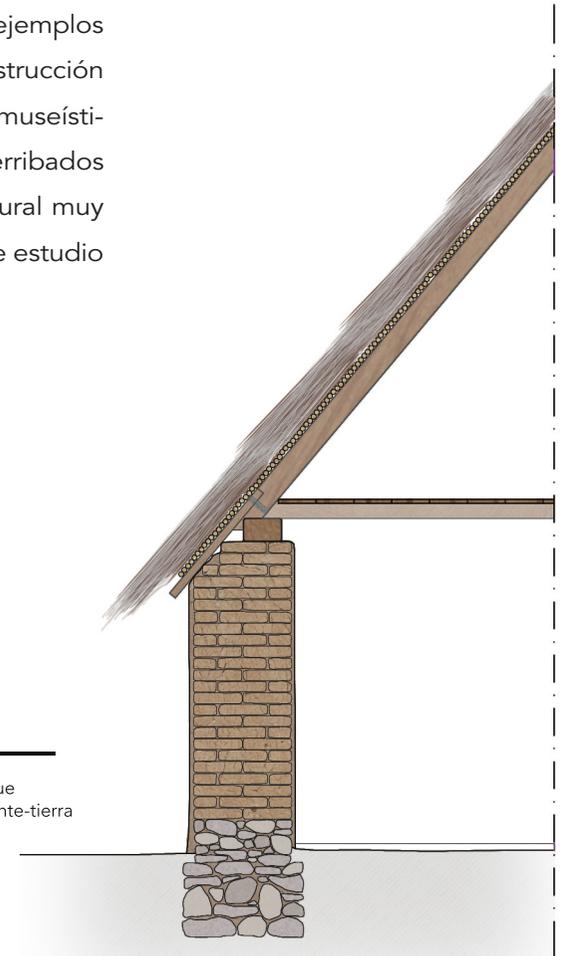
Sección constructiva parcial de la barraca realizada con muros de adobe y cubierta vegetal.
